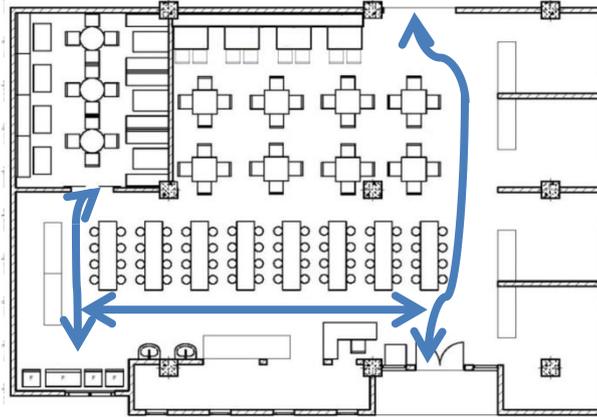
Denah Cafeteria UB dengan zonasi ruang
